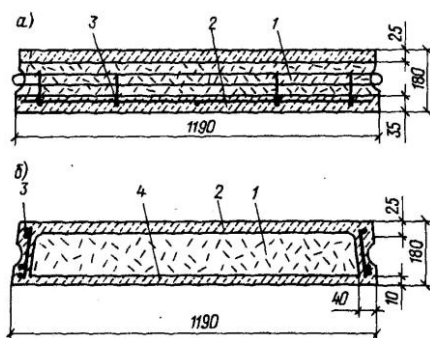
Поперечные сечения композитных конструкций плит перекрытия для жилых и общественных зданий: а — плита трехслойная для перекрытия пролета 4.8 м; б — плита с боковыми ребрами для пролета 6 м: 1 — арболит класса не ниже В1 для варианта а, В2 для варианта б-2 — бетон класса не ниже В15; 3-рабочая арматура классов А-П или А-Ш; 4 — цементно-песчаный раствор М100
